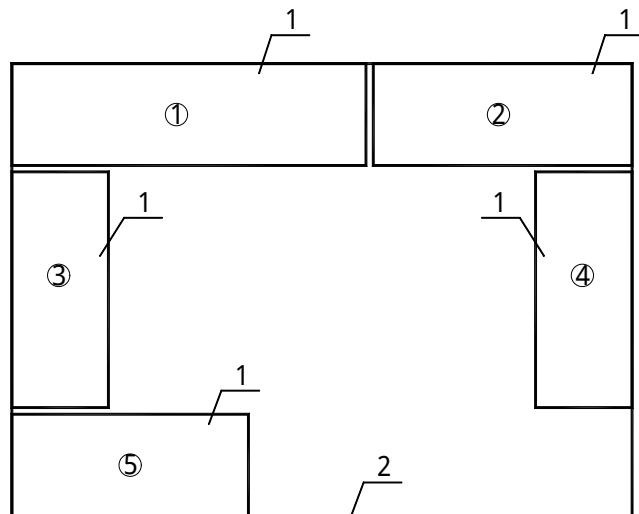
农村院落中独立房屋编码单元平面示意
